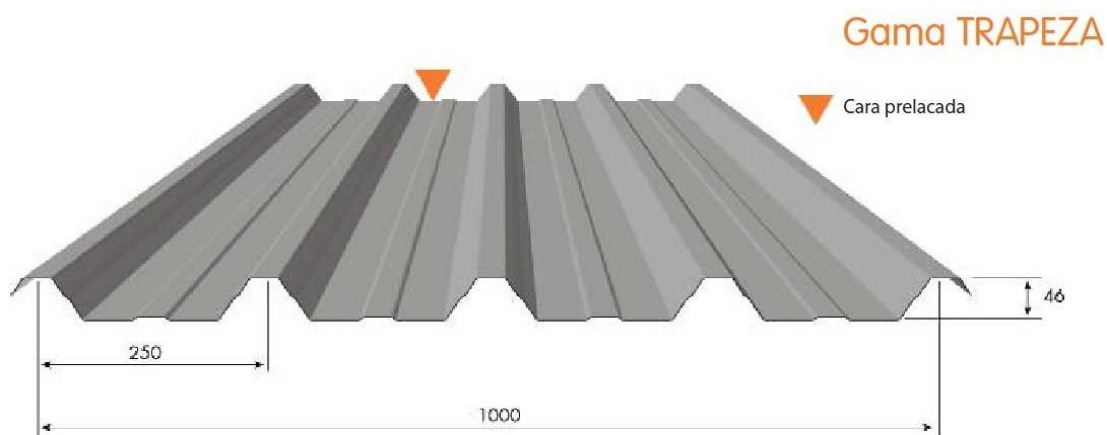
Chapa trapezoidal de la gama Trapeza (dimensiones en mm)
